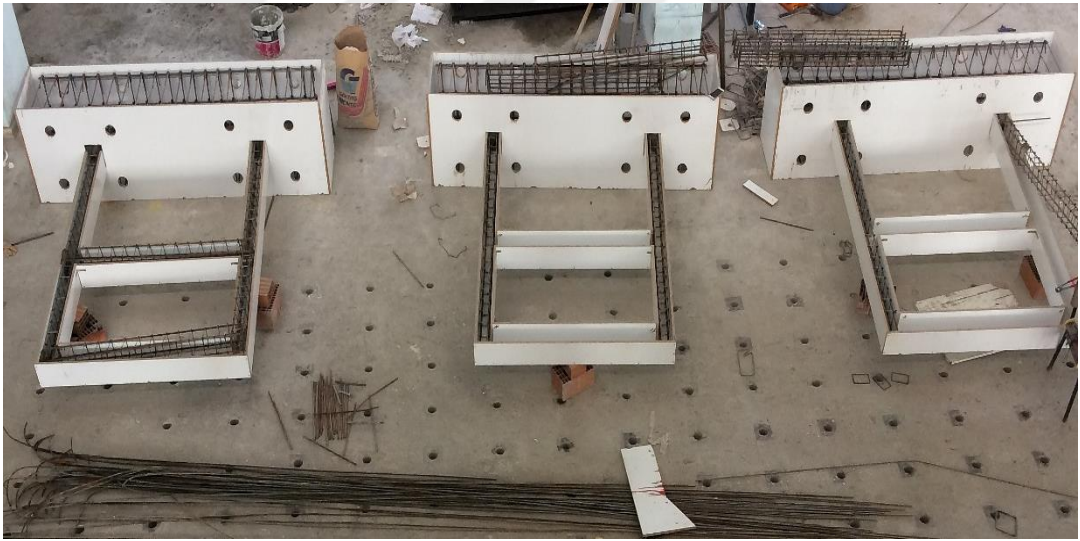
Kalıp montajı tamamlanmış çerçeveler
